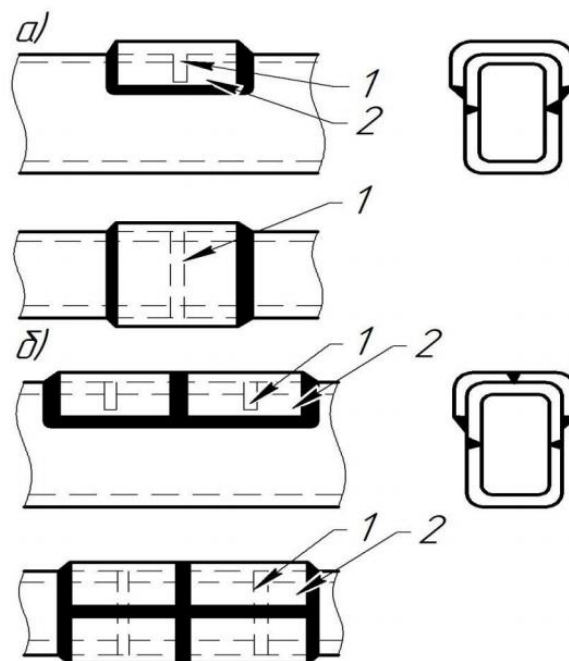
Схеми конструктивних підсилень швів після зварювання тріщини
